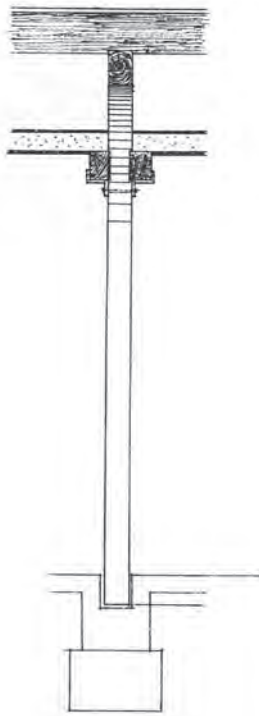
Dettaglio della costruzione della finestra da tetto / *Detalj konstrukcije krovnog prozora.
